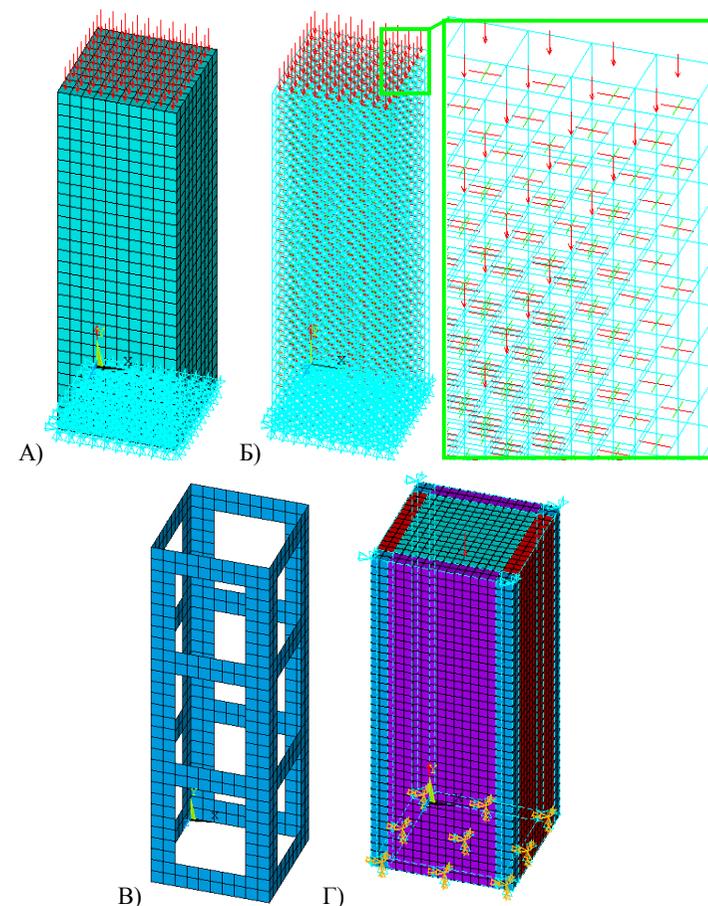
Расчетные схемы (А- не усиленный простенок; Б- простенок с армированием; В- простенок усиленный стальной обоймой; Г- простенок усиленный железобетонной обоймой)
